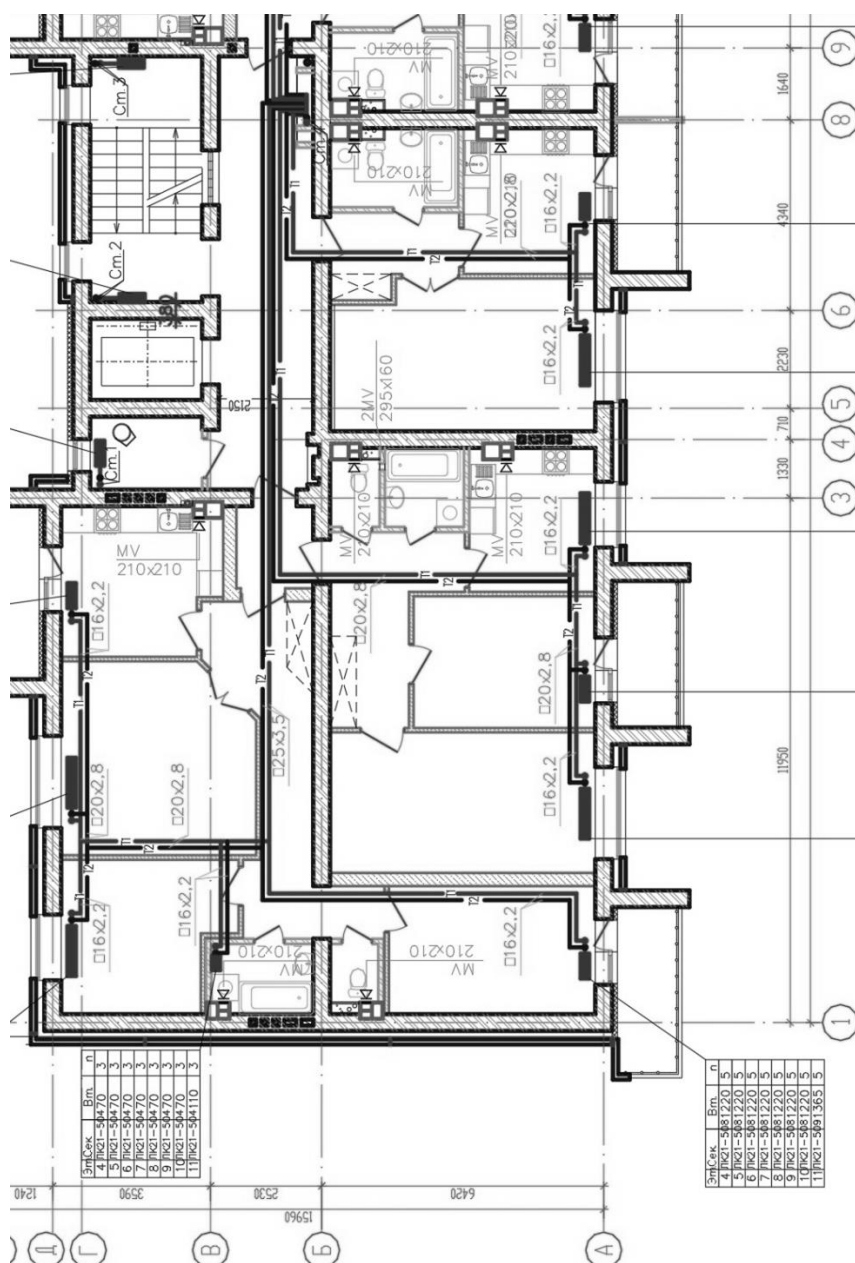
План 11 этажа в осях 1-12 с элементами системы отопления
